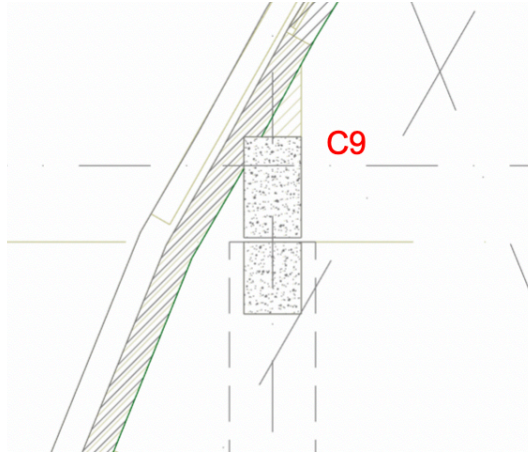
Definición en planta de pilar C9. Fuente Elaboración Propia
